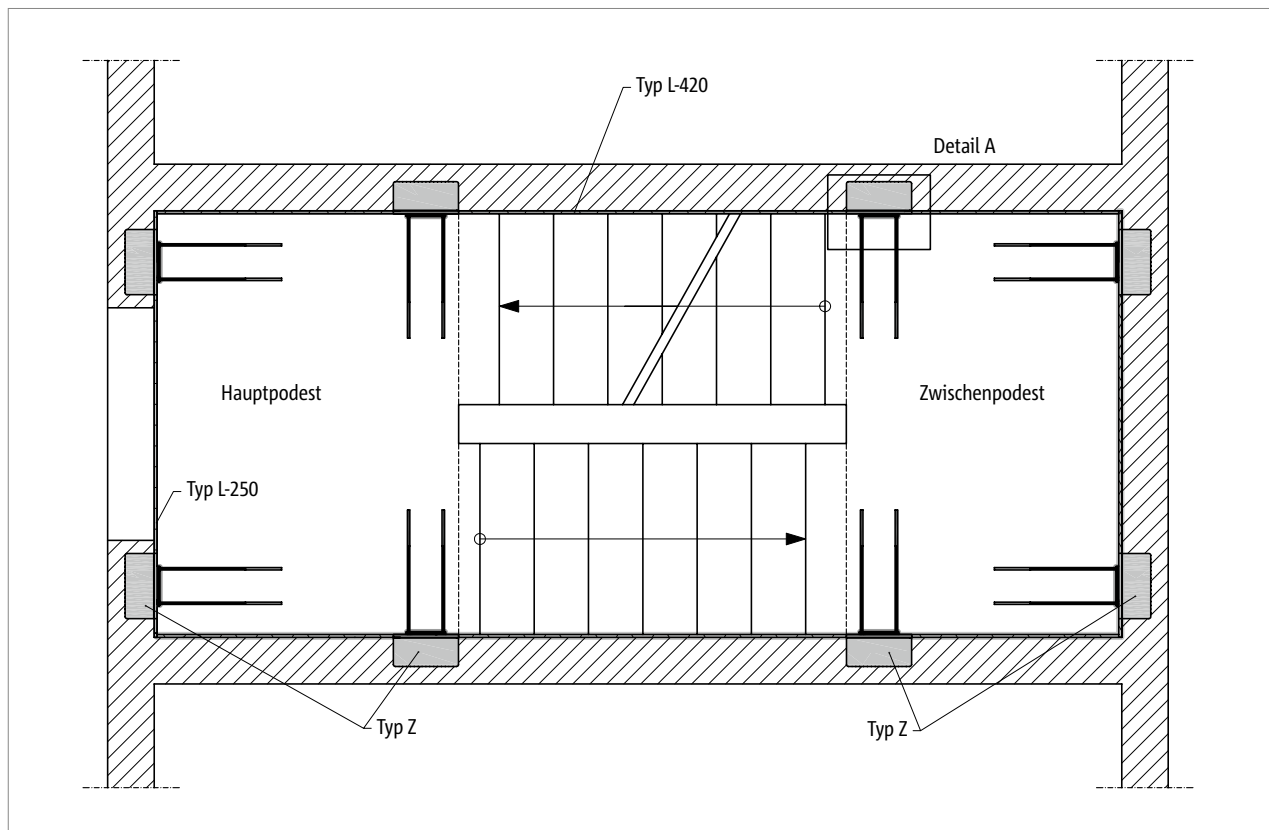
Schöck Tronsole® Typ Z: Alternative Elementanordnung im Grundriss
